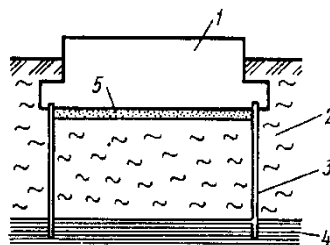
Усиление основания с помощью шпунтового ограждения:
